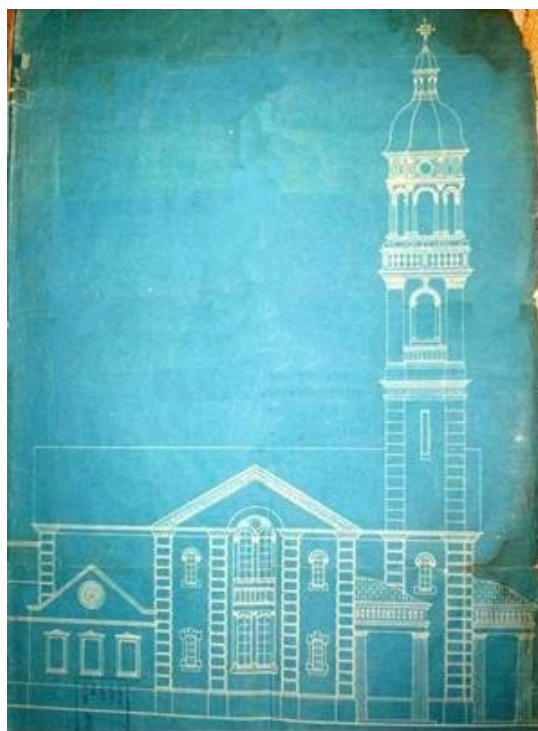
desenho da planta da Catedral, atribuída a Theodoro Gründel, 1922
